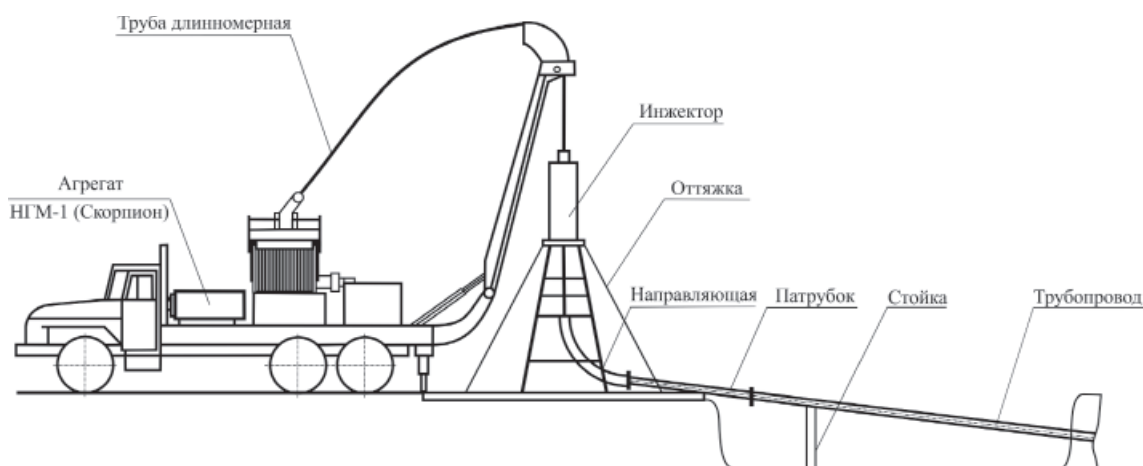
Схема протяжки полиэтиленовой трубы в стальной трубопровод
